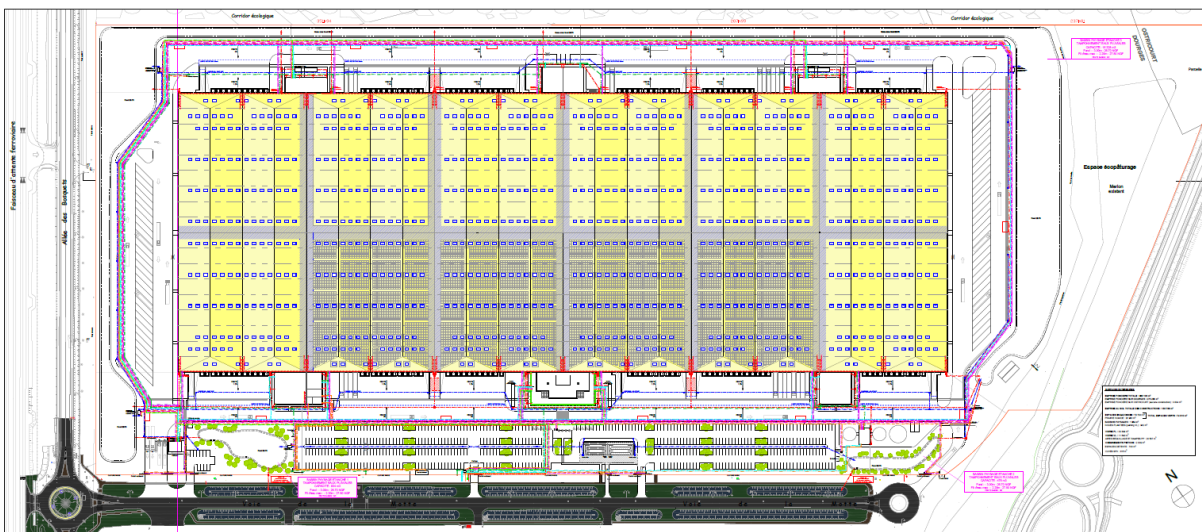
Plan d'implantation des panneaux photovoltaïques
